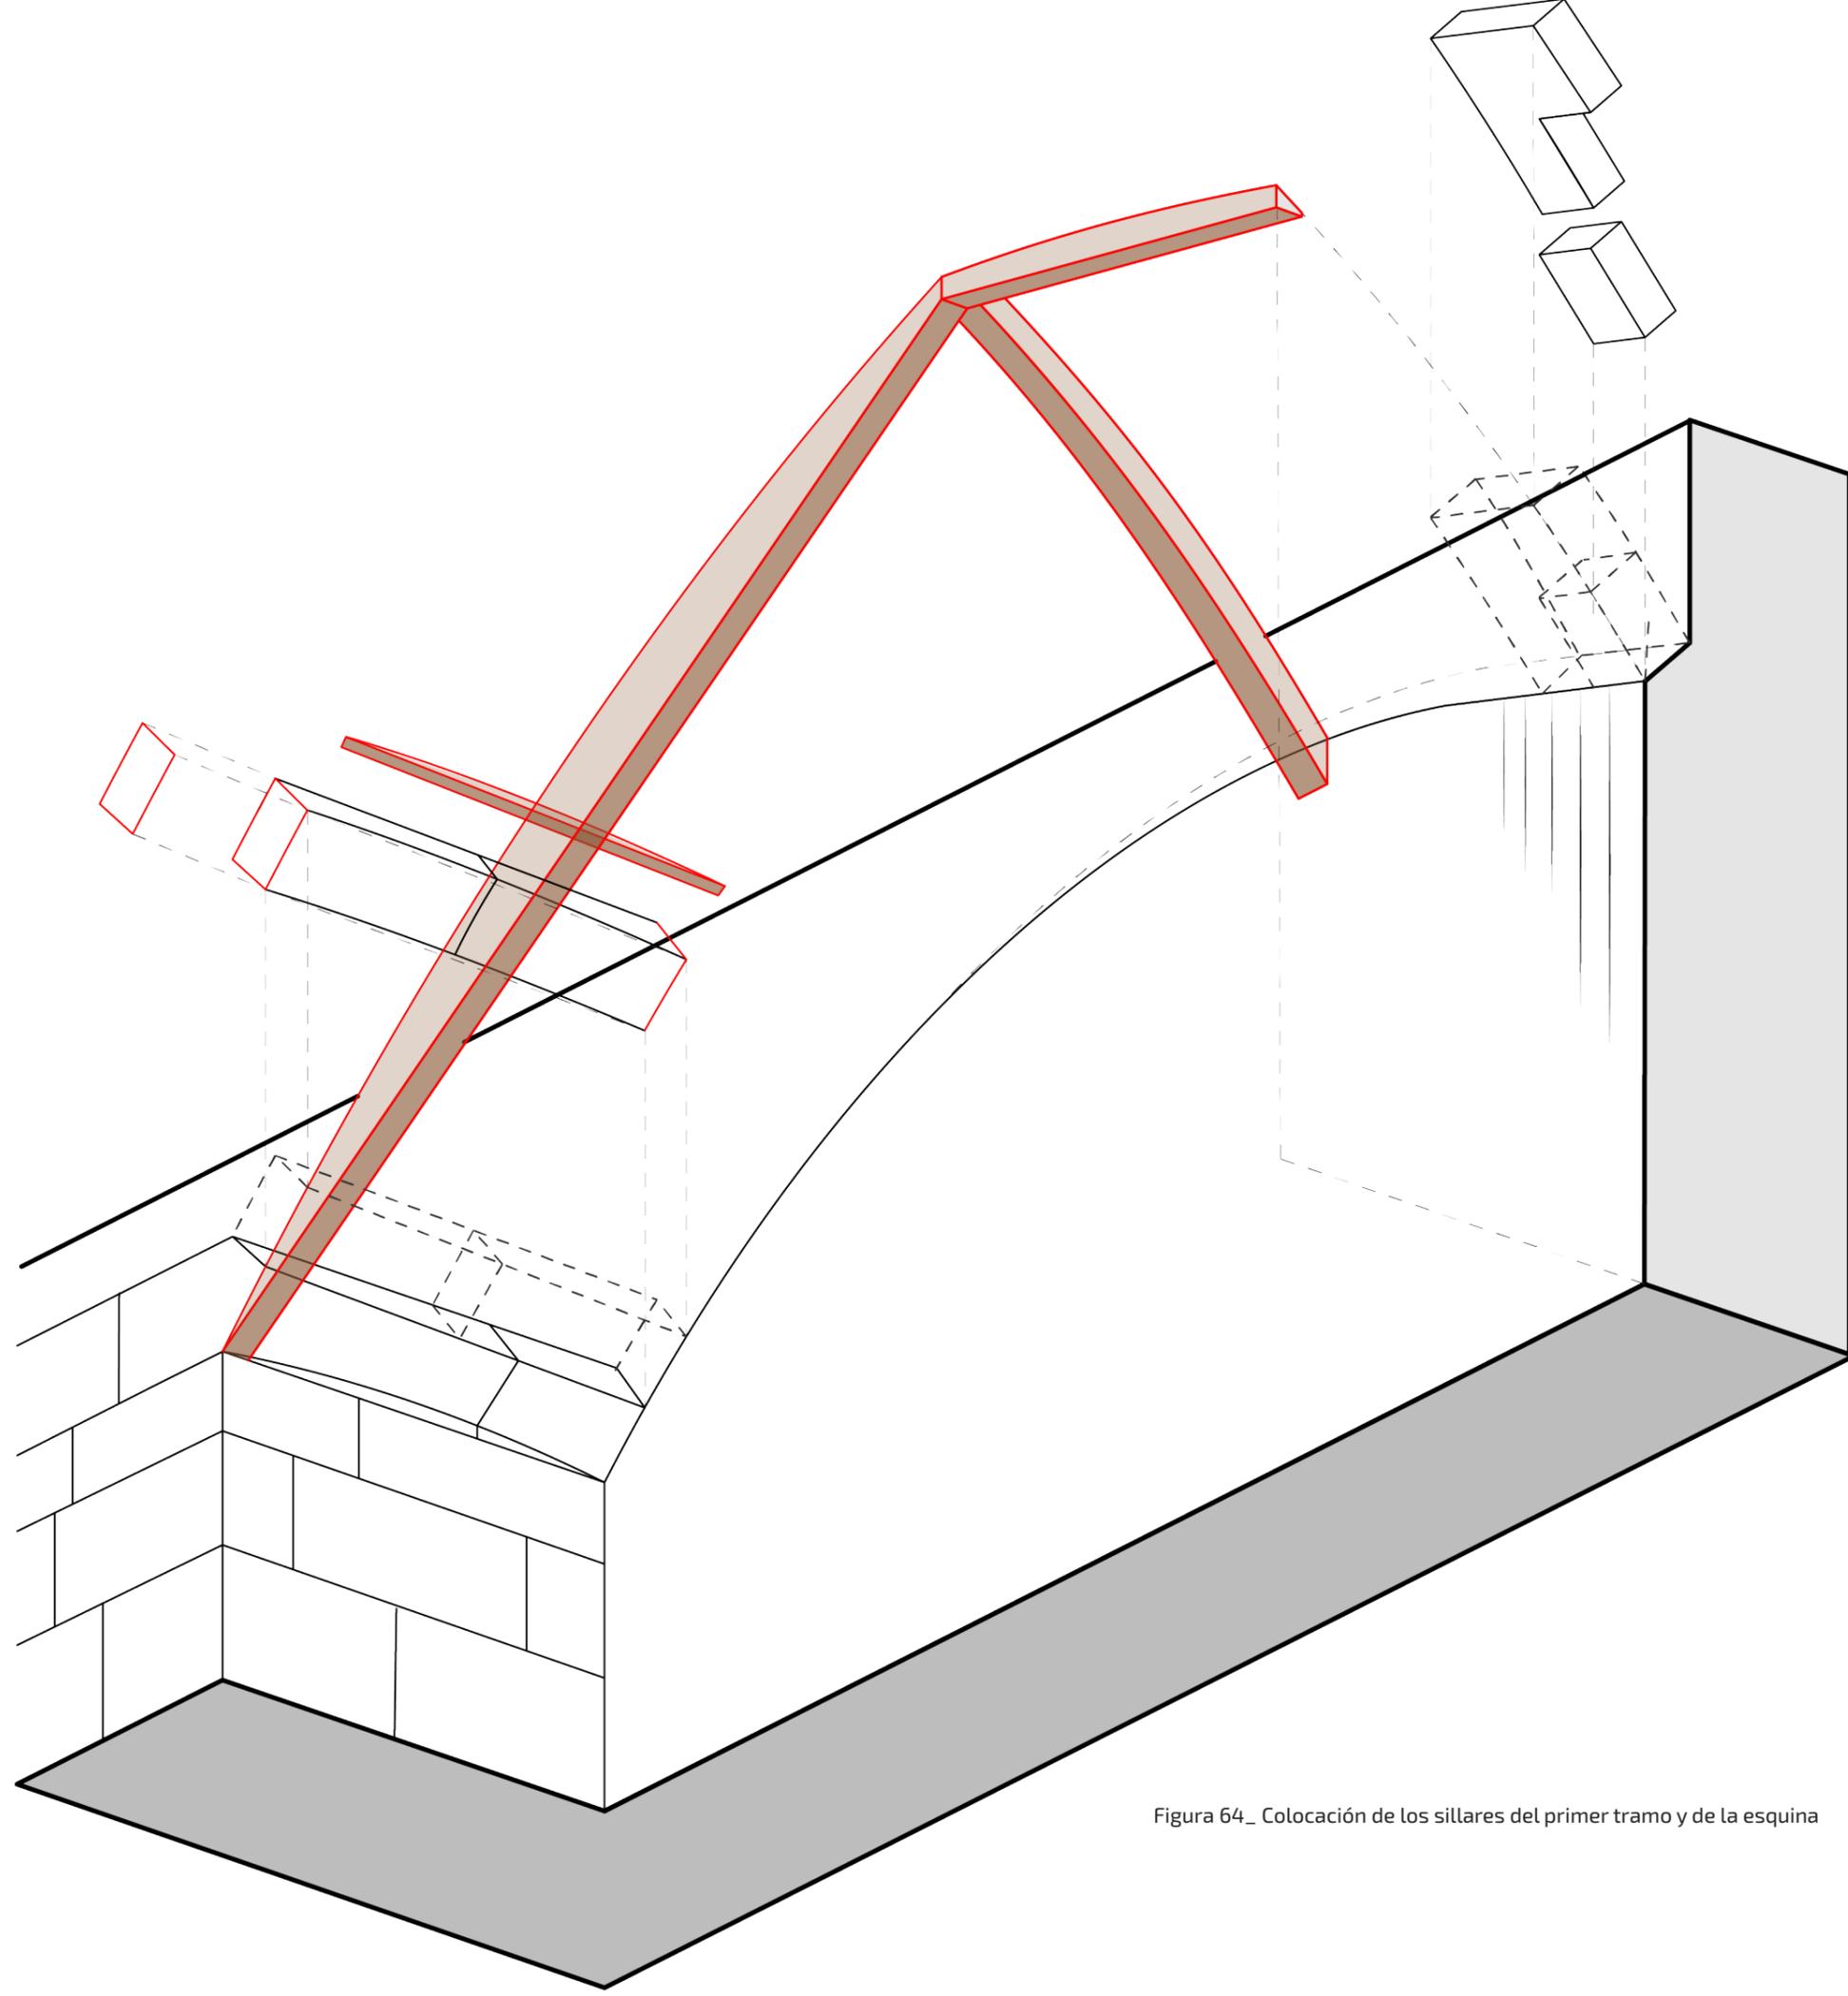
Colocación de los sillares del primer tramo y de la esquina
